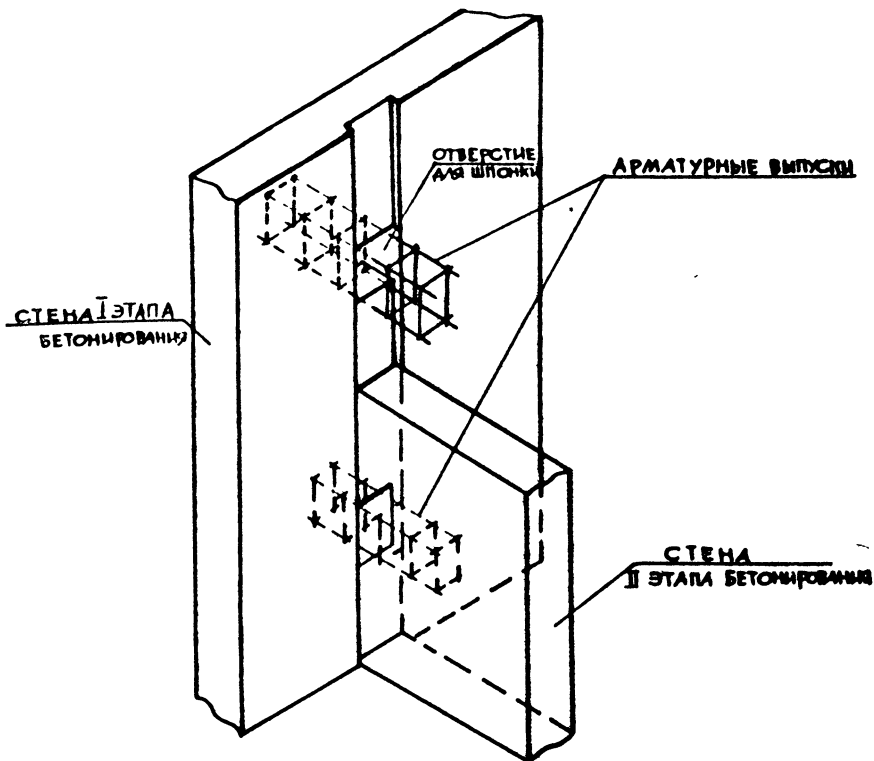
в. Шпонажные контактные вертикальные стыковые соединения монолитных стен, бетонируемых поэтапно с дискретно расположенными по высоте стены сквозными шпонками
